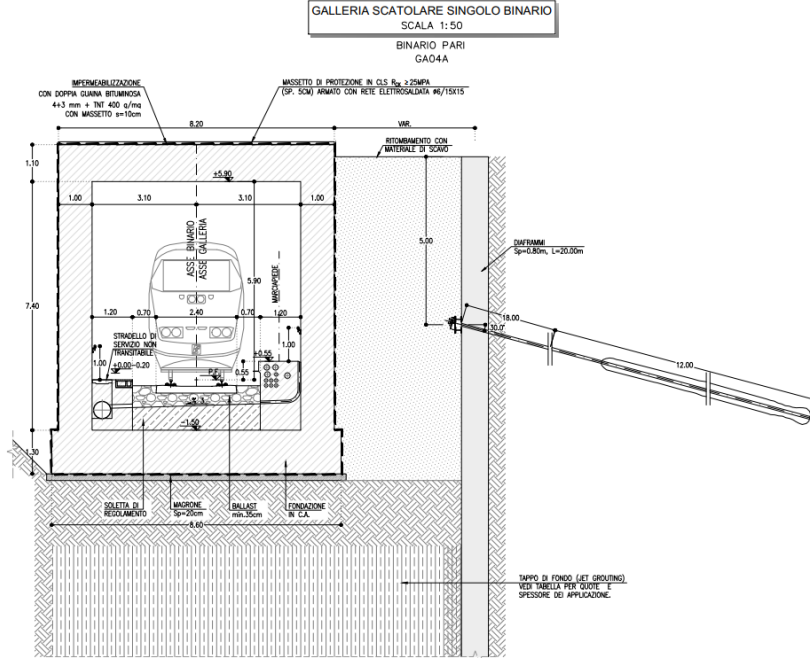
Sezione Galleria GA04A tratto su diaframmi
